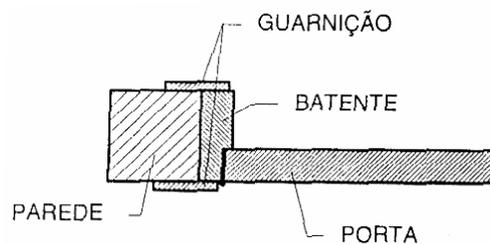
Hachuras – exemplos de detalhes de um batente.
